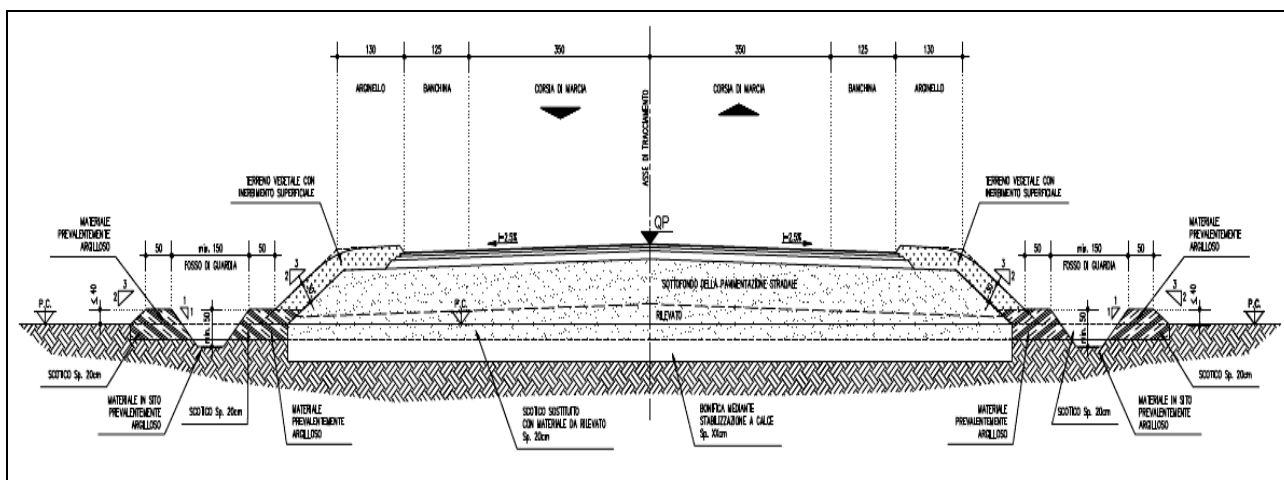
SEZIONE TIPO VIA IMPERIALE CAMURANA DI NUOVA PROGETTAZIONE
